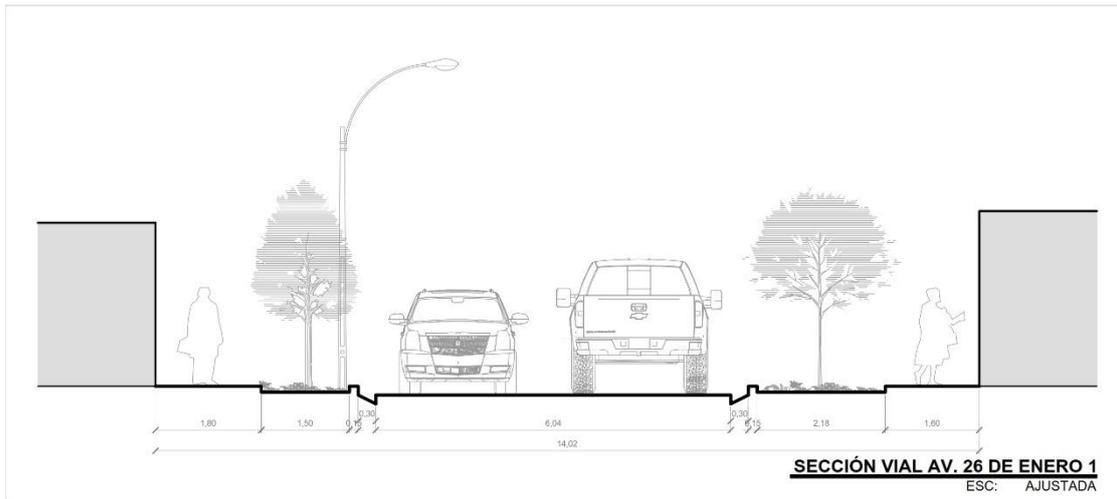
Sección Vial 4 – Avenida 26 de Enero Primera Cuadra.
